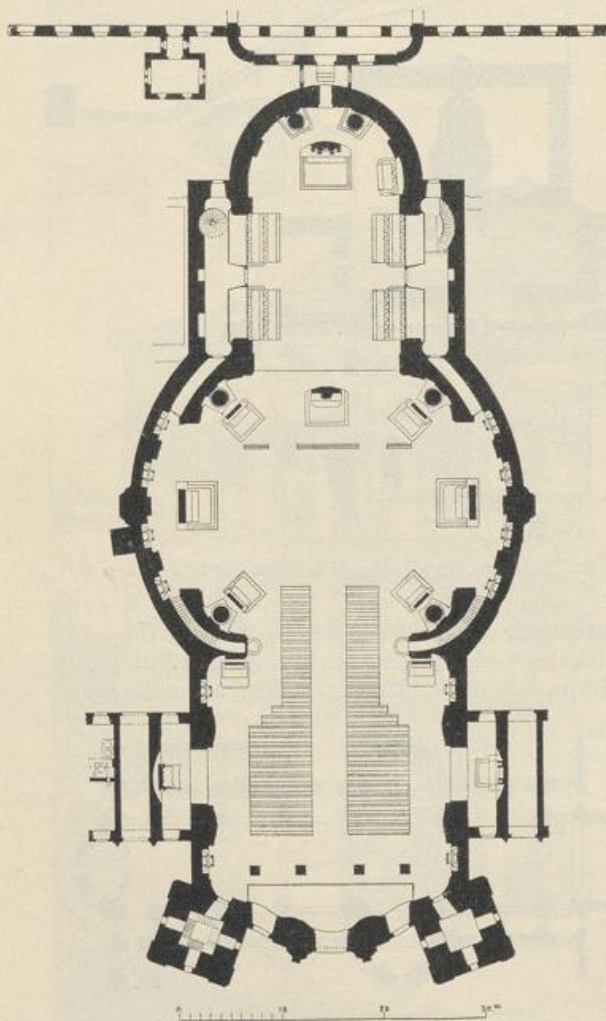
Grundriß der Klosterkirche zu Wiblingen
